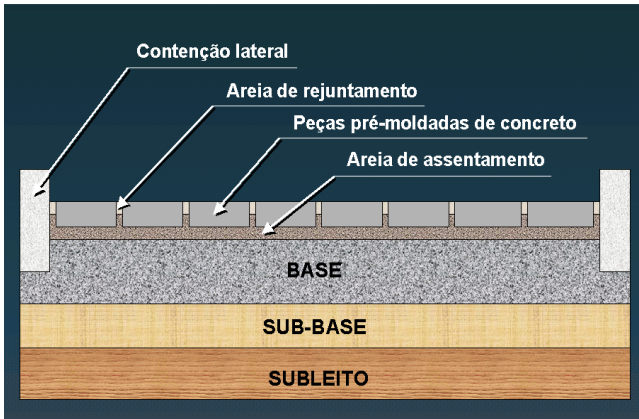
Estrutura do Pavimento Intertravado (HALLACK, 1998 *apud* MULLER, 2005).
